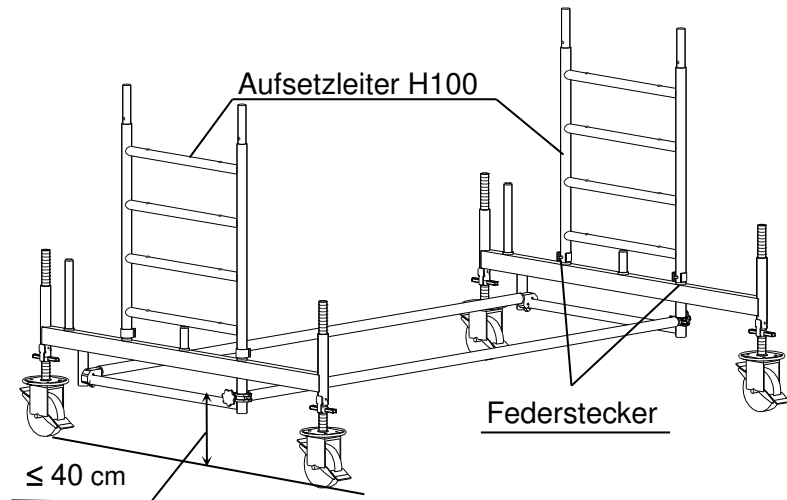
Grundeinheit mit Fahrbalken L180 – mittige Stellung
